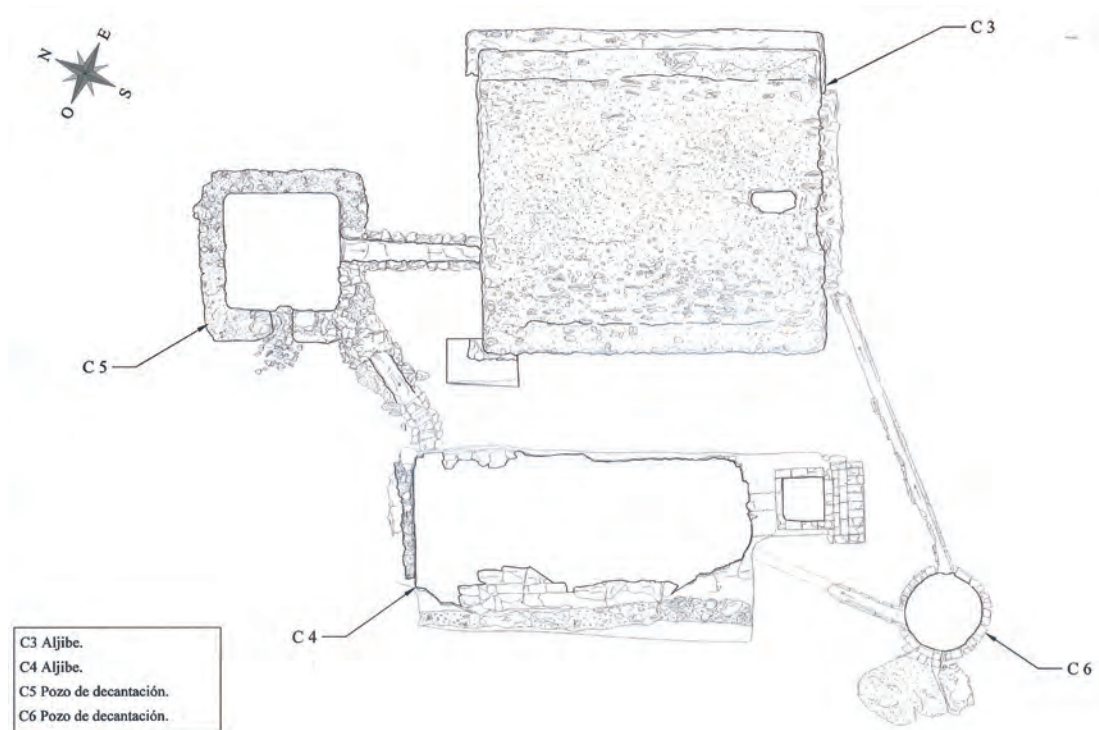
Planta de los aljibes C-3 y C-4, pozos de decantación C-5 y C-6 y sistemas de conducciones.
